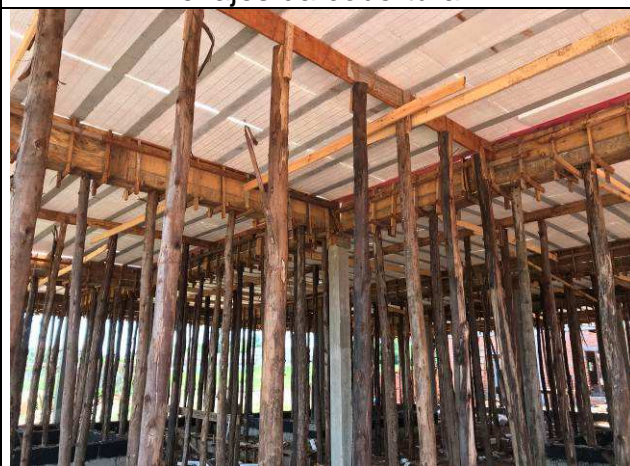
C: Formas e armaduras das vigas e lajes da cobertura.
